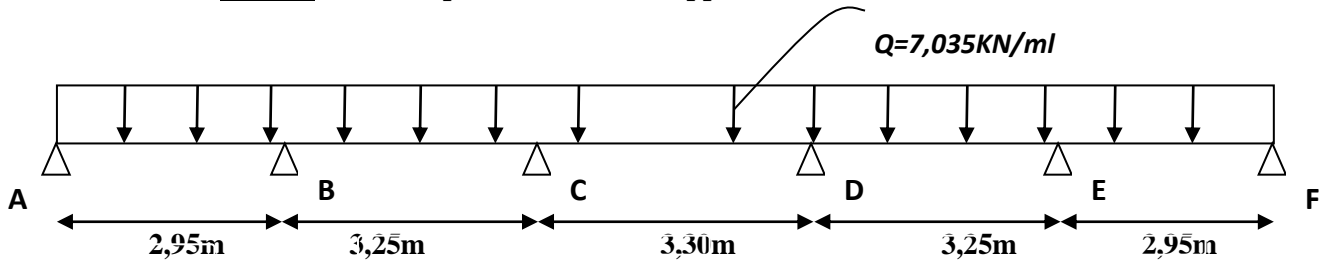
Schéma statique de la poutre à 6 appuis.
